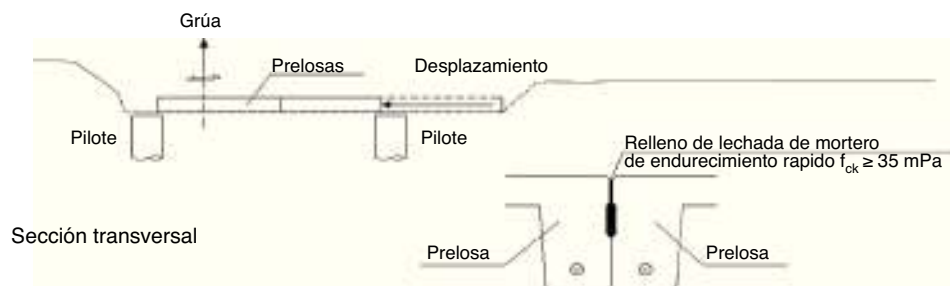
Colocación de las piezas en pi sobre las vigas corridas.
